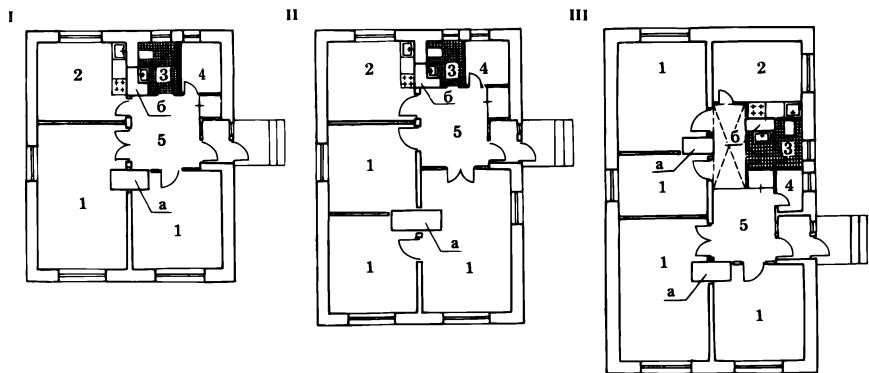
Схема расположения отопительных печей и обогревательных щитков
